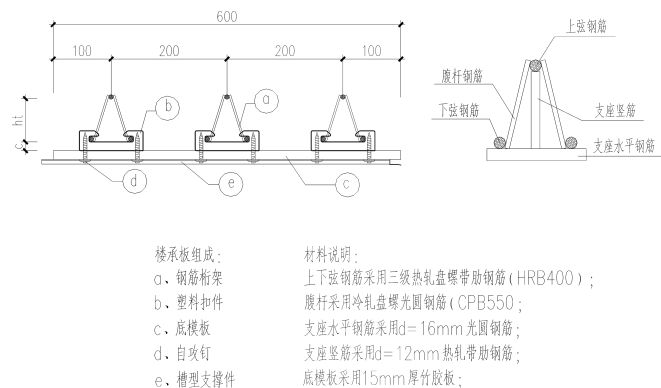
TDD 装配可拆式钢筋桁架楼承板剖面图
